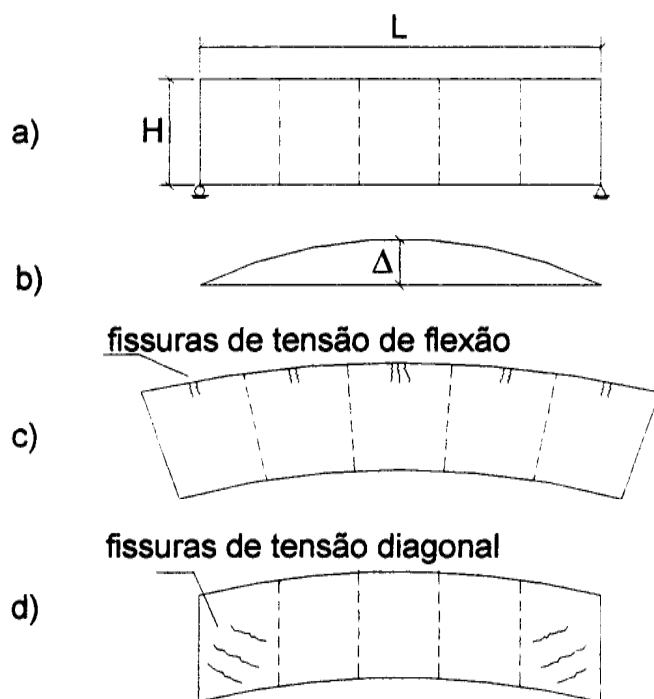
Modelo de viga-parede apresentado por Boscardin & Cording (1989): (a) Descrição geométrica; (b) Deflexão gerada por uma carga central; (c) Fissuras geradas por tensões de tração devido à flexão; (d) Fissuras geradas por tensões de tração devido ao cisalhamento (modificado - Burland et al., 1977)
